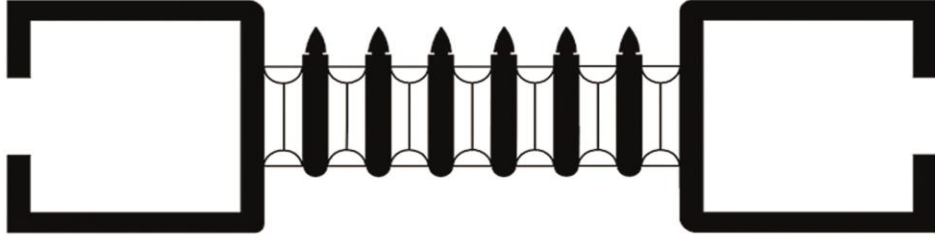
المسقط الأفقي لأسوار وسطح القنطرة
